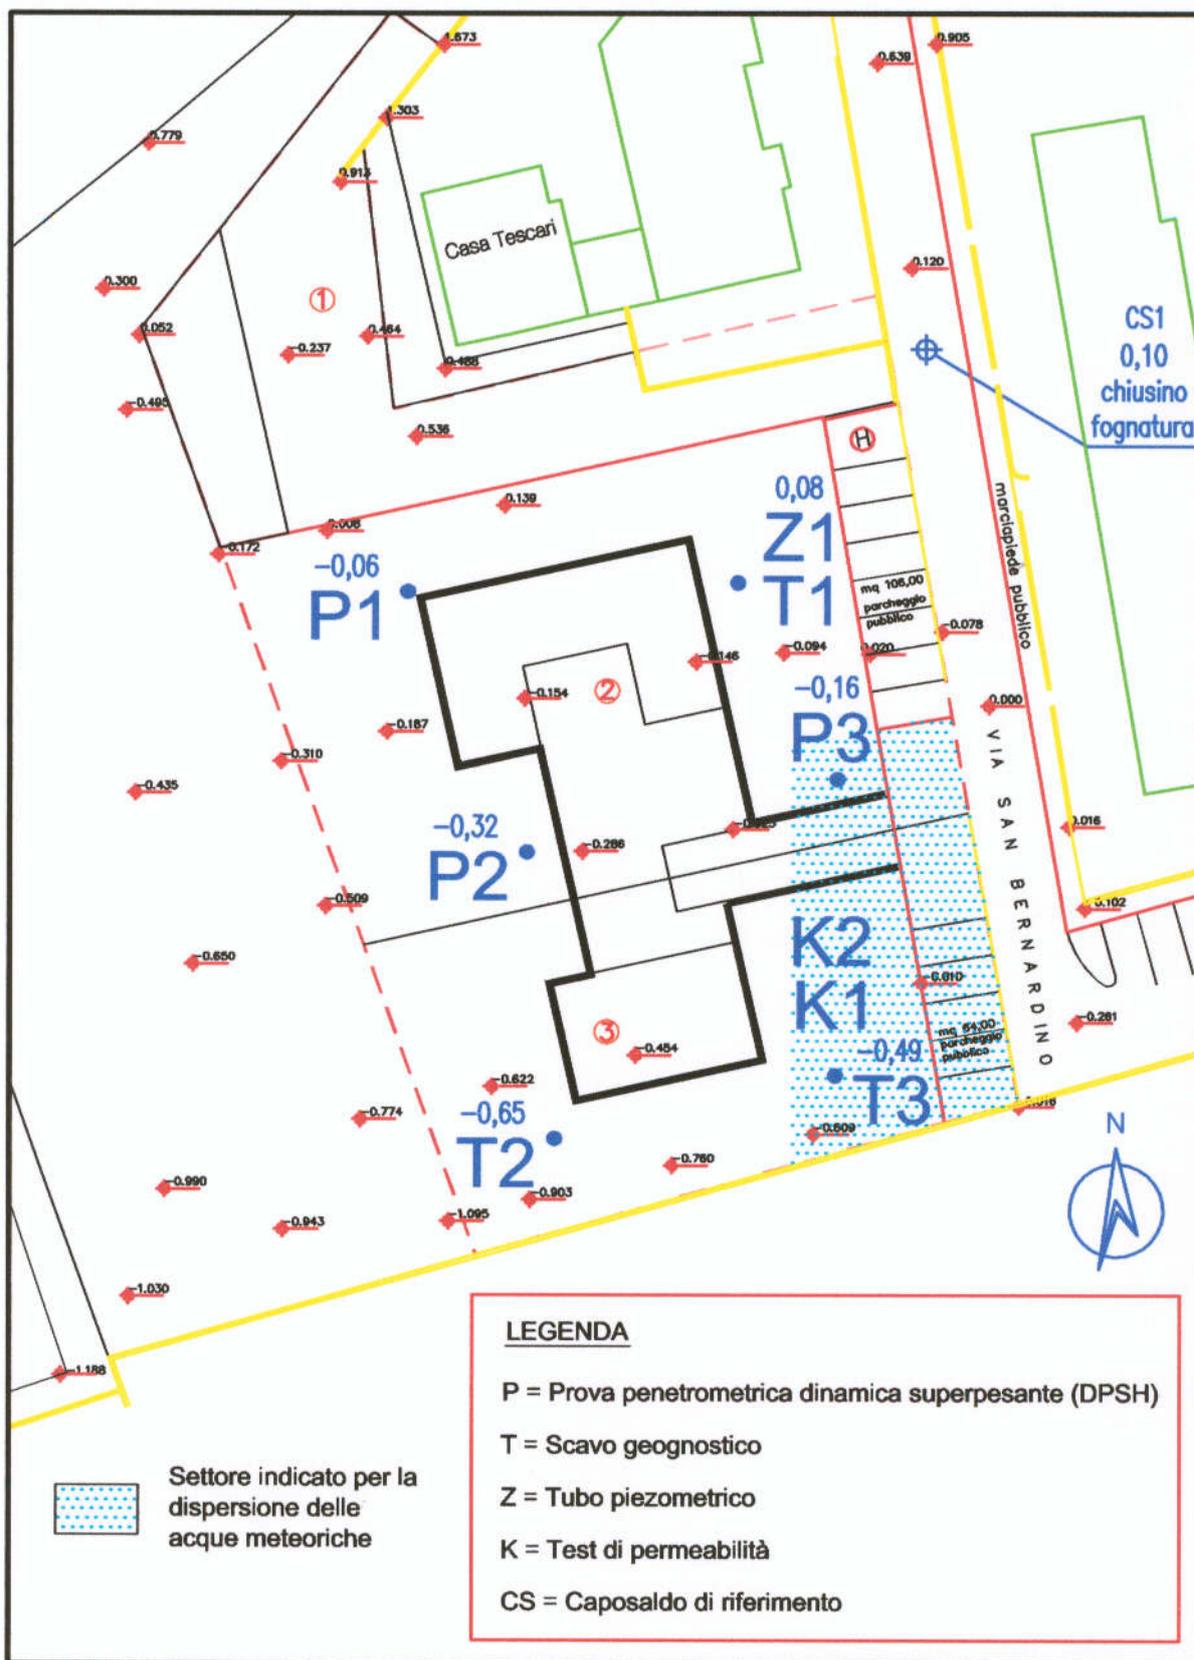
Planimetria alla scala 1:500 con l'ubicazione delle prove in sito
